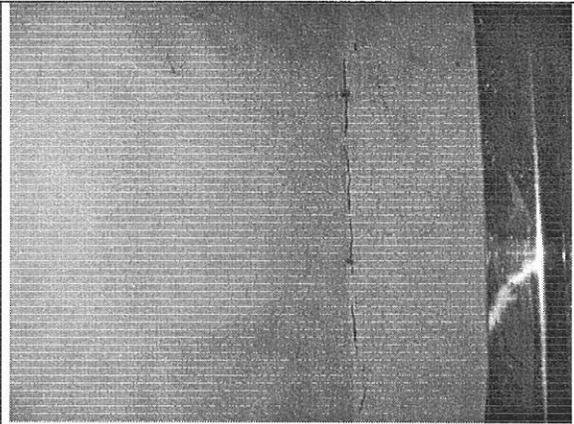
Grieta vertical que marca la junta entre muros
